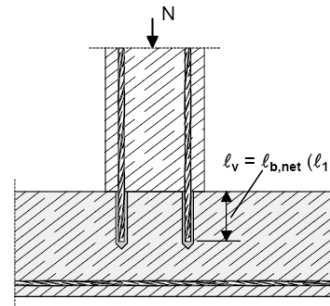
Ancrage direct d'armatures pour élément principalement en compression. Les armatures subissent une contrainte en compression
